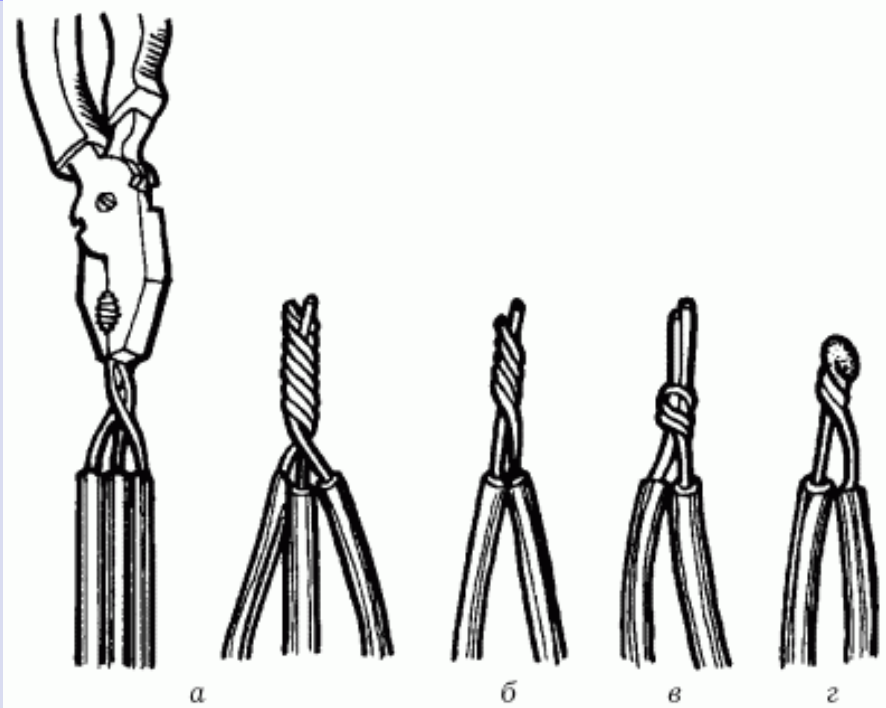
Способ скрутки под сварку: а – алюминиевые жилы; б, в – алюминиевая и медная жилы; г – готовое сварное соединение.
